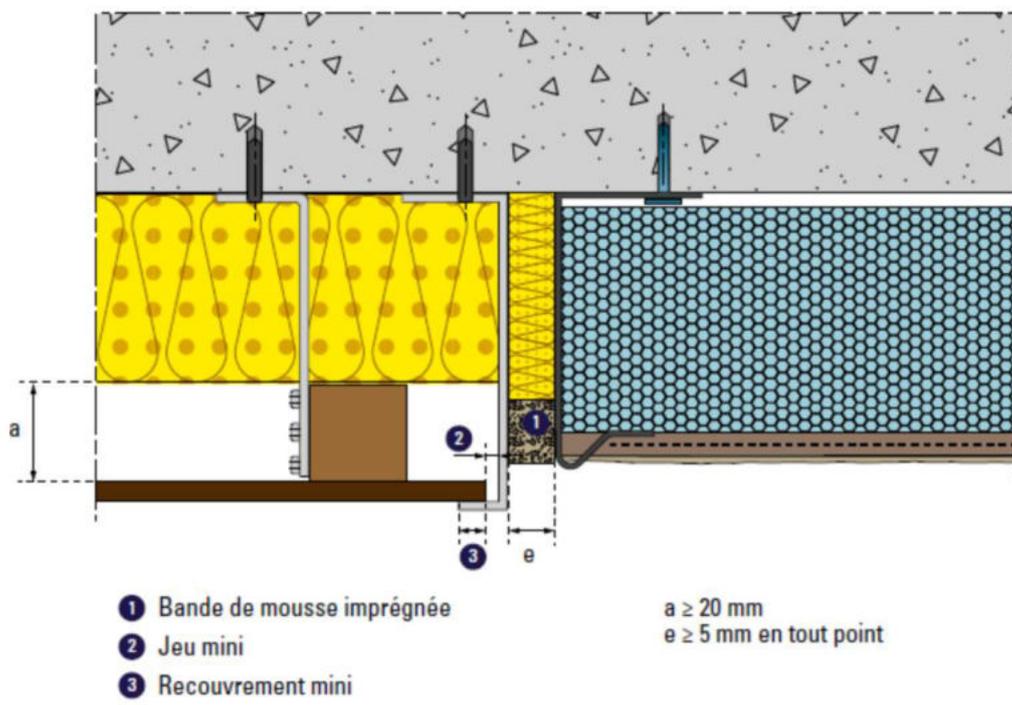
Jonction avec procédé d'enduit sur isolant – coupe horizontale
